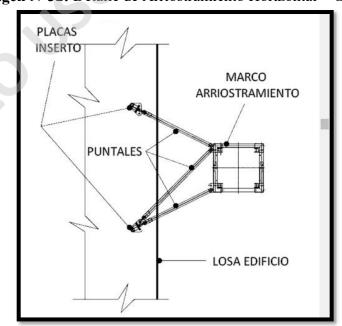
Detalle de Arriostramiento Horizontal – Grúa Torre
